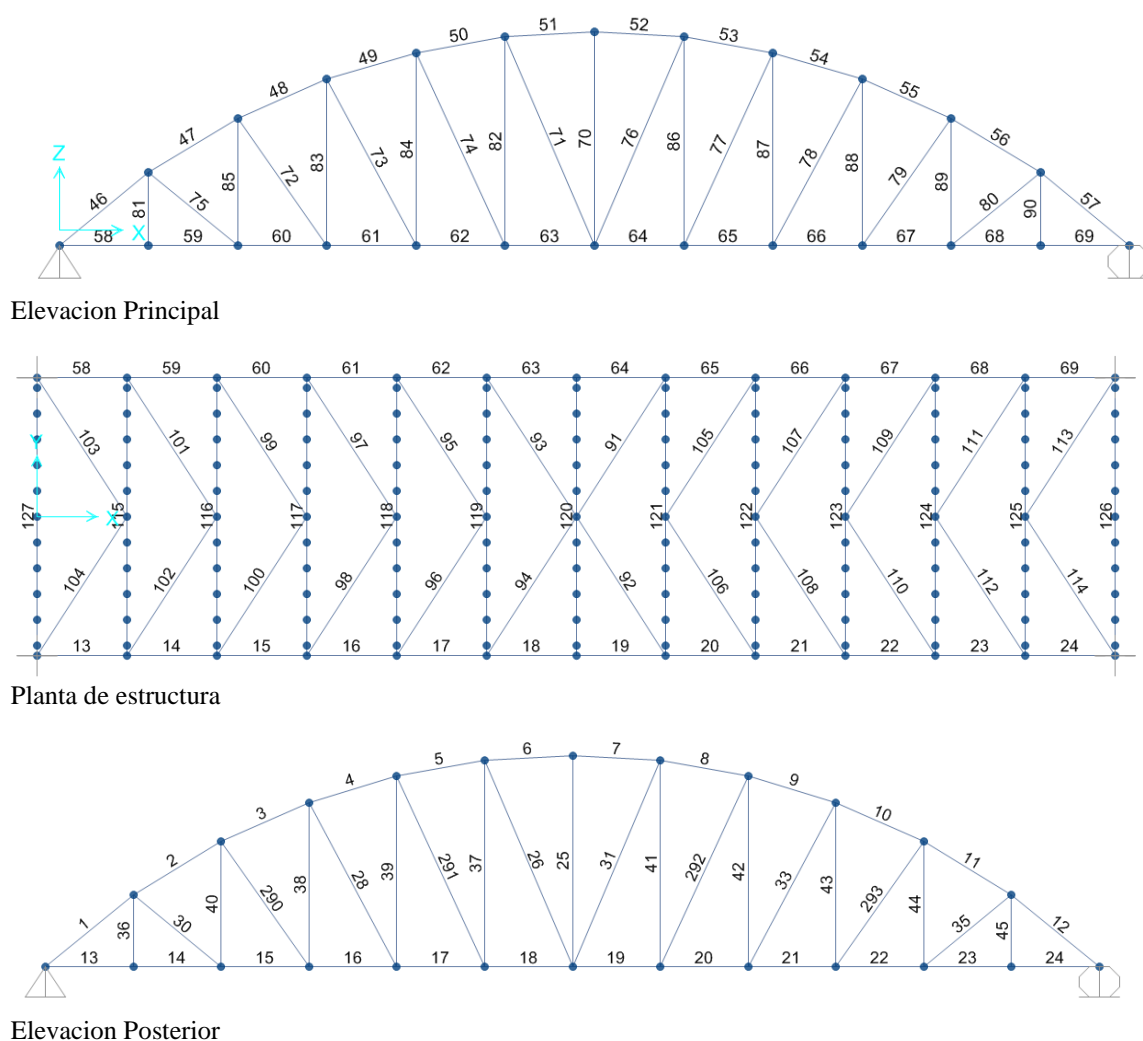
Nomenclatura a los elementos de cercha o armadura
